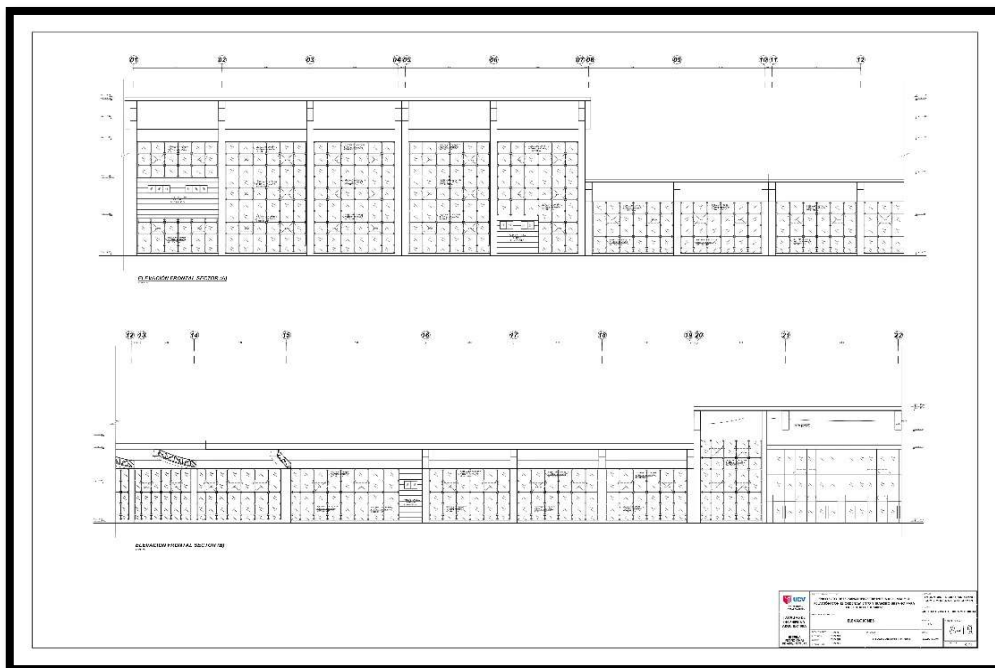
Plano Elevación Frontal; Sector (A, B). Fuente: Elaboración Propia.
